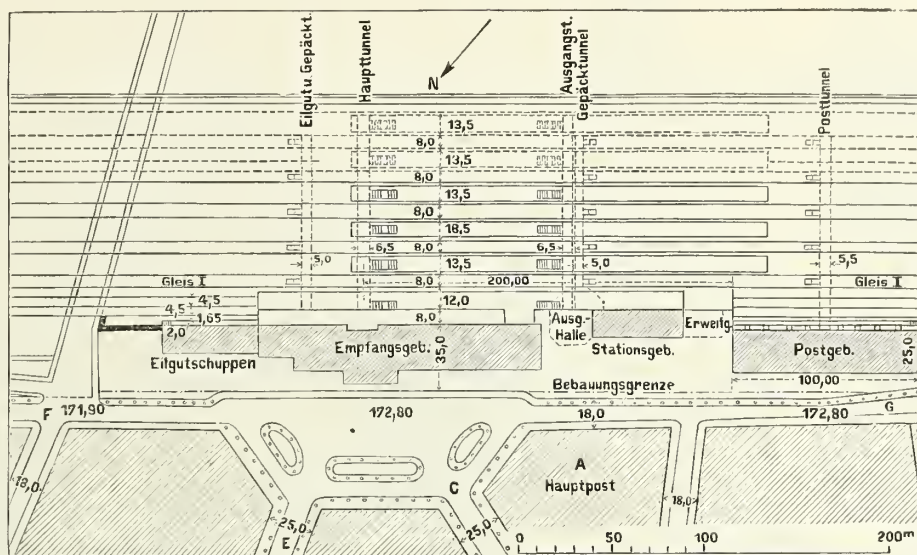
Lageplan zum Empfangsgebäude, Stationsdienstgebäude und Postgebäude auf Bahnhof Metz.
